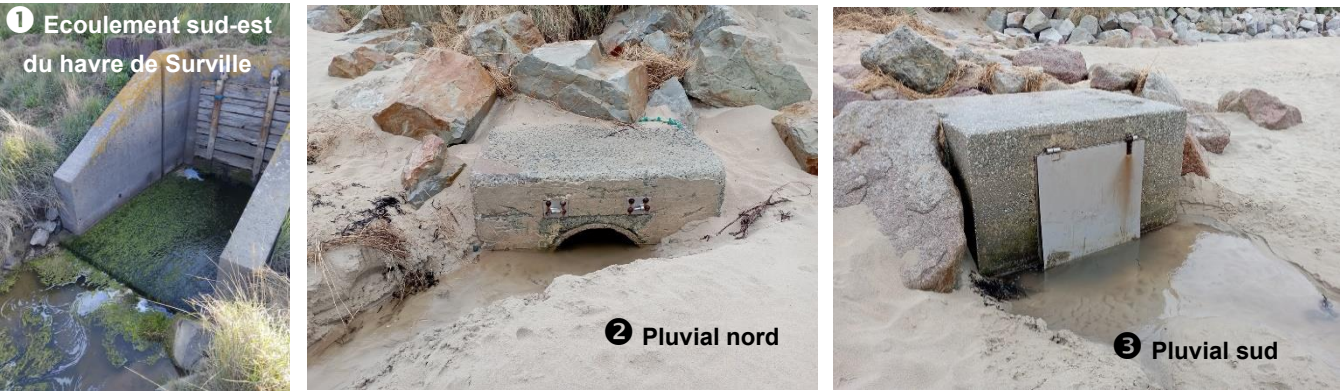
Vues sur les émissaires pluviaux du havre de Surville et de Denneville-Plage – CD50 (Mai 2024)
